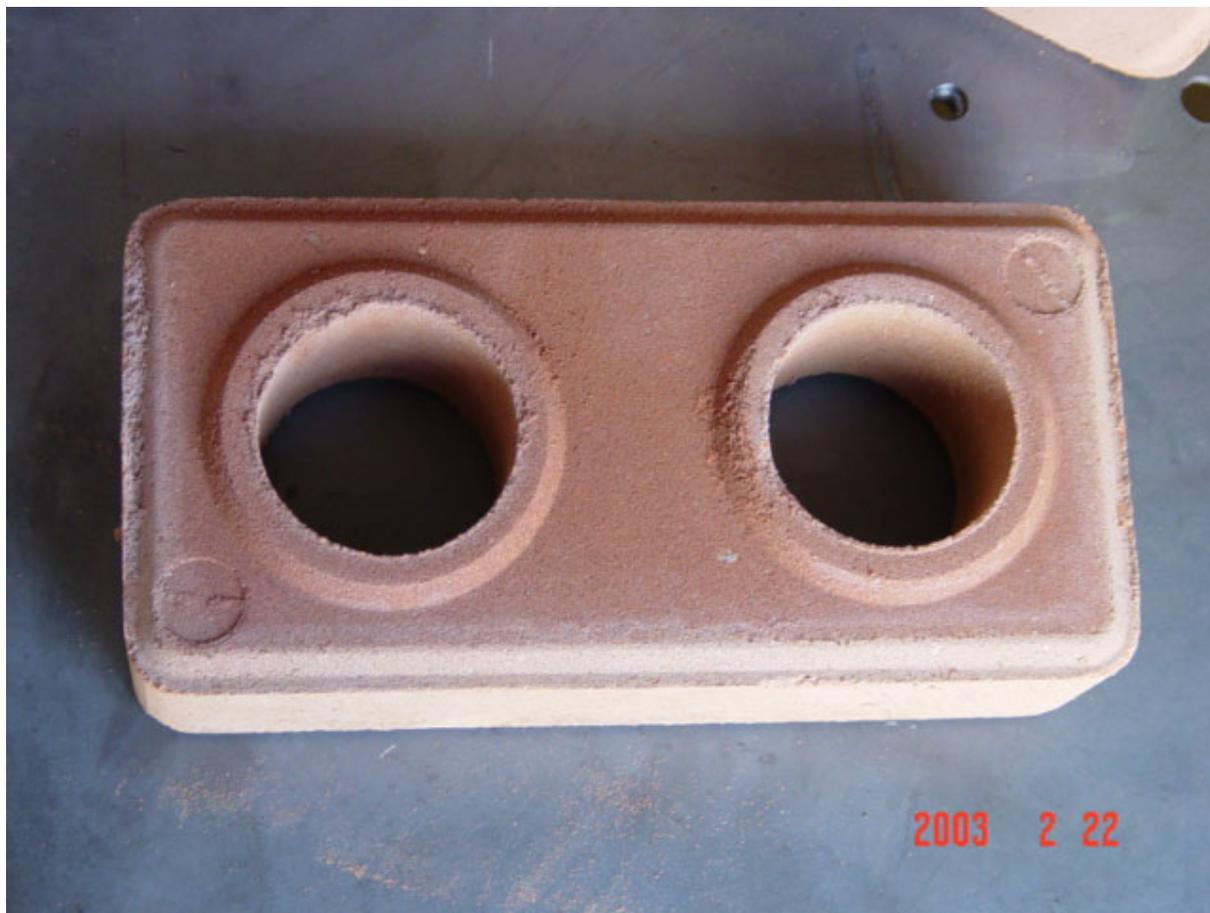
detalhe dos furos com o encaixe saliente, que fica para cima durante o assentamento, do tijolo de solo-cimento com 6,25 x 12,5 x 25 cm.
